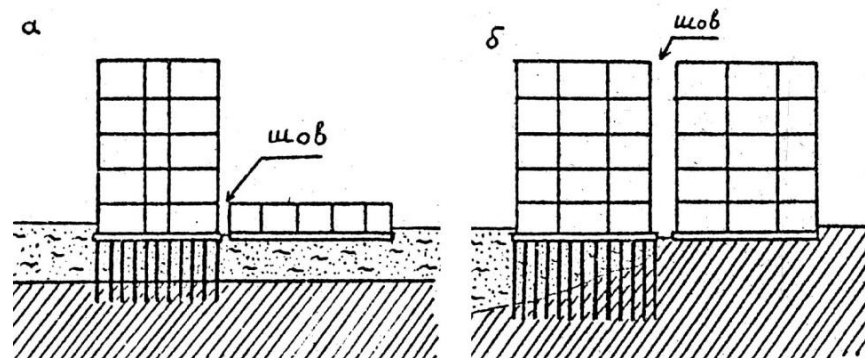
Тип оснований и фундаментов: а – разные по нагрузкам фундаменты при одинаковом грунтовом основании; б – одинаковые по нагрузкам фундаменты при разных грунтовых основаниях.
